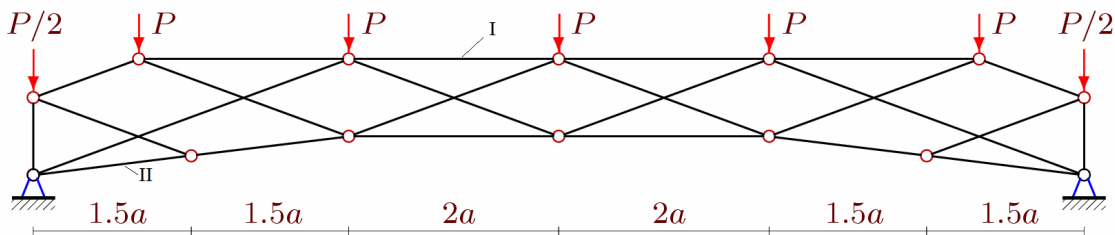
Нагрузка на верхний пояс фермы, $n = 3$
